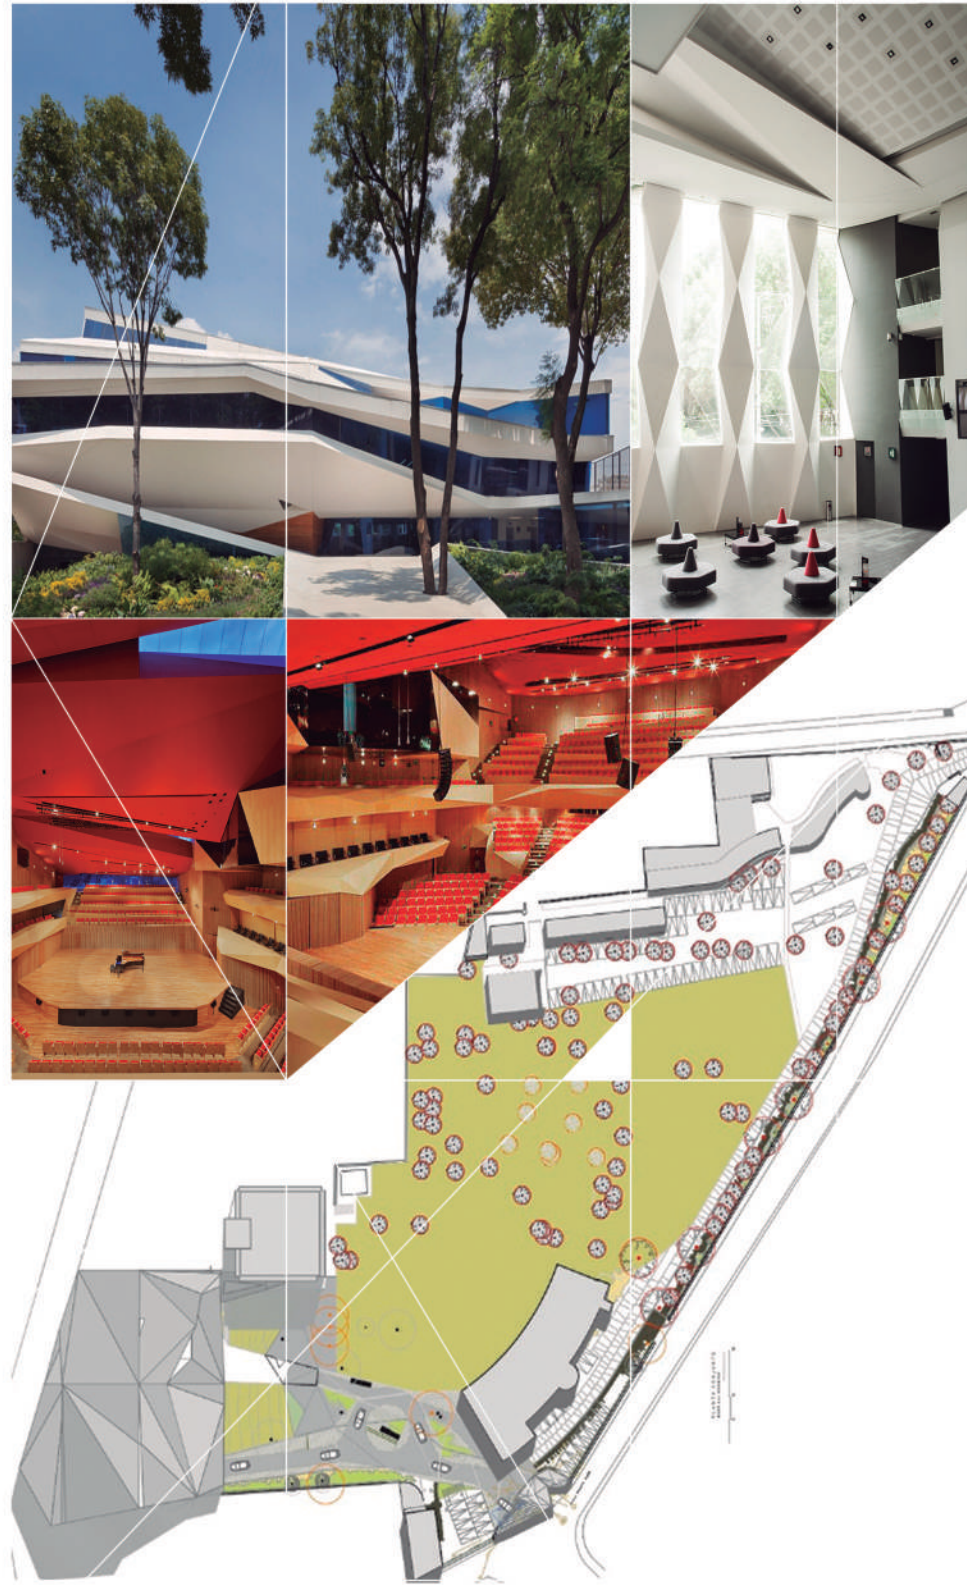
Vista de acceso Centro Cultural Roberto Cantoral. Broissin Architects. Fuente Archdaily, 2012.
